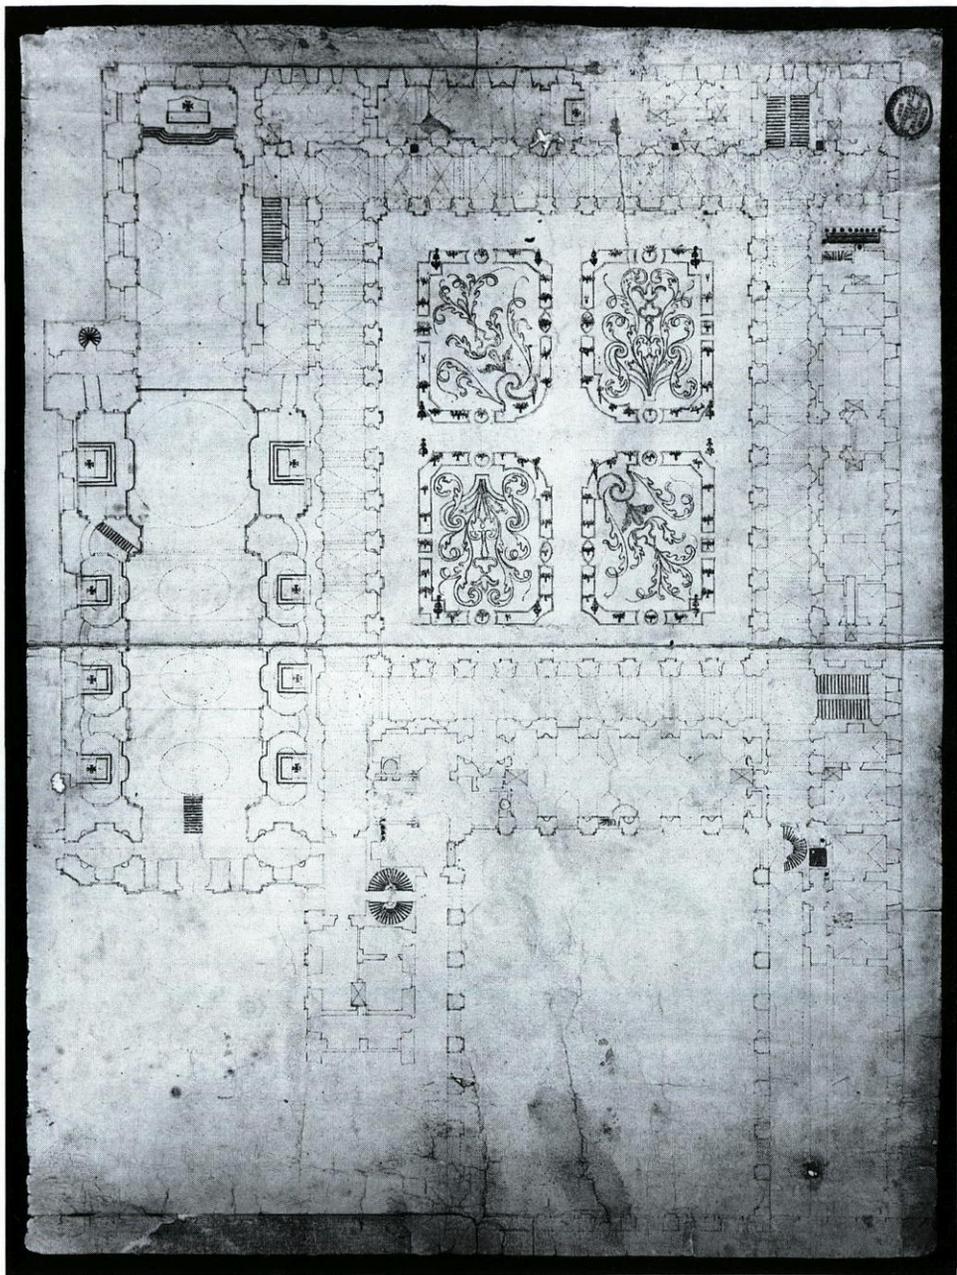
Grundriß des Klosters Waldsassen. Zeichnung von Frater Philipp Muttone, 3. Viertel 18. Jahrhundert. (Foto: Wagnüller, Regensburg)
